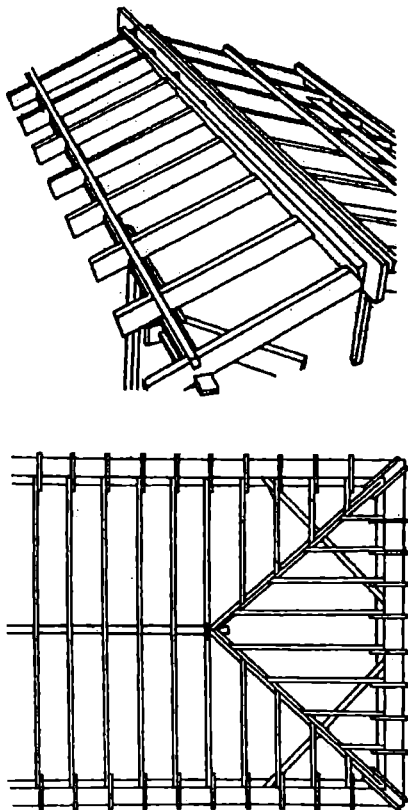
Варианты стропильной кровли для покрытия стальными профилированными листами
